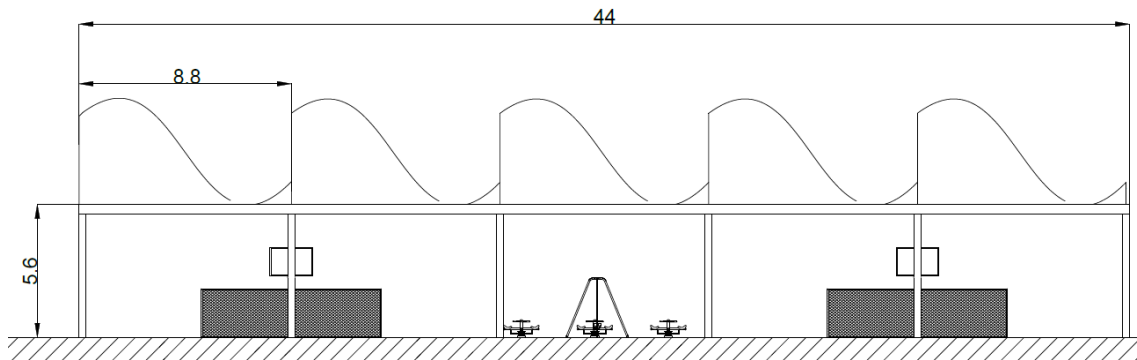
Sección Transversal bóveda propuesta Fuente: Elaboración propia
